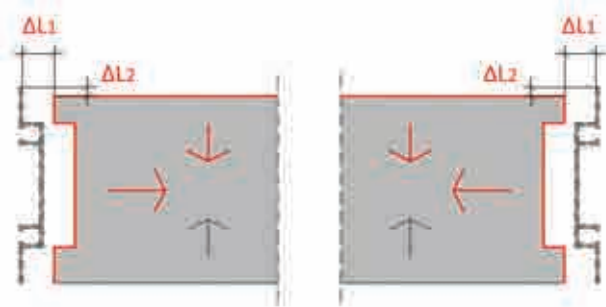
Desvinculación entre el molde perimetral y el panel debido a la retracción del hormigón
